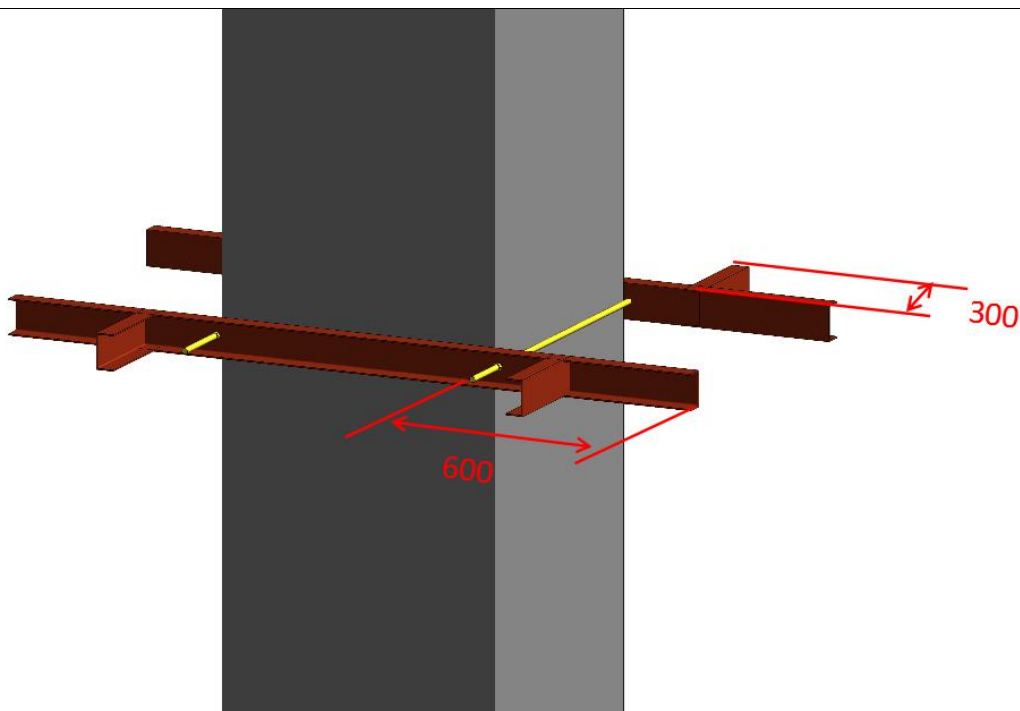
抱柱固定支撑示意图（高处拼焊作业平台辅助设施）
